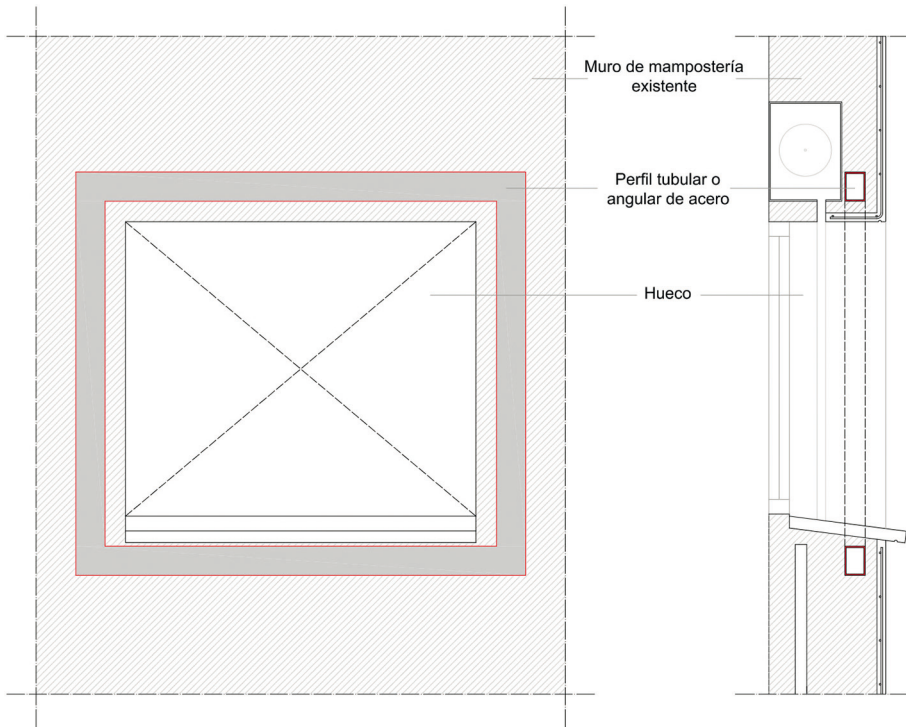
Recercado metálico en hueco. Esquema en alzado y sección.
